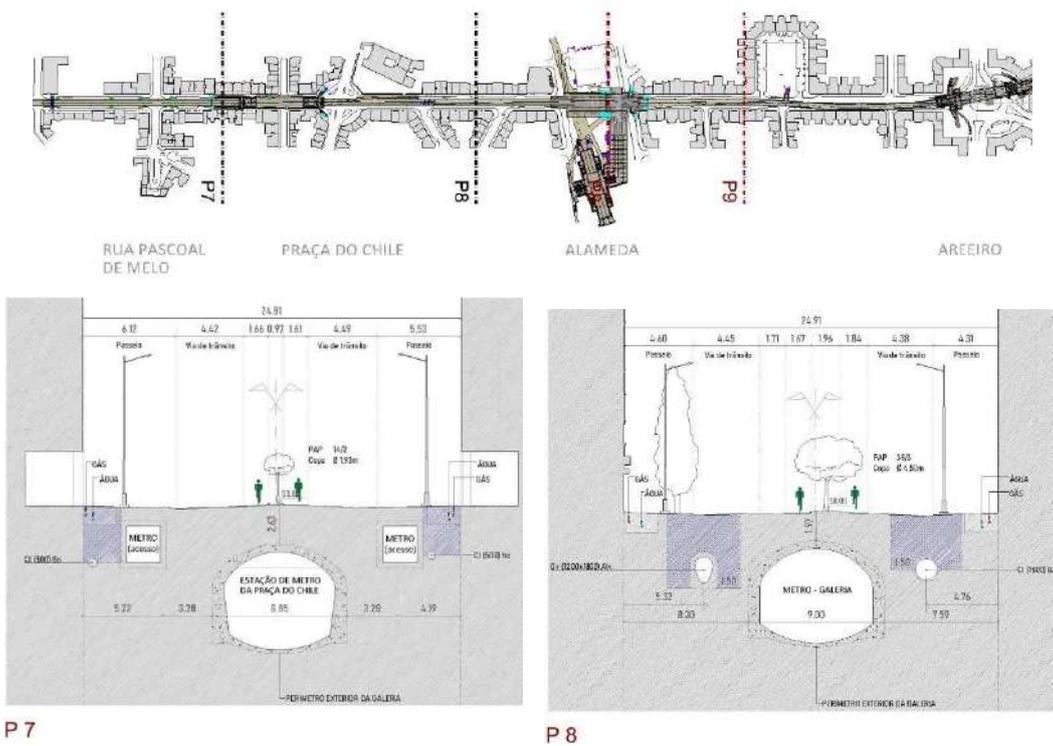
Planta e perfis P7 e P8 com identificação das infraestruturas de subsolo
